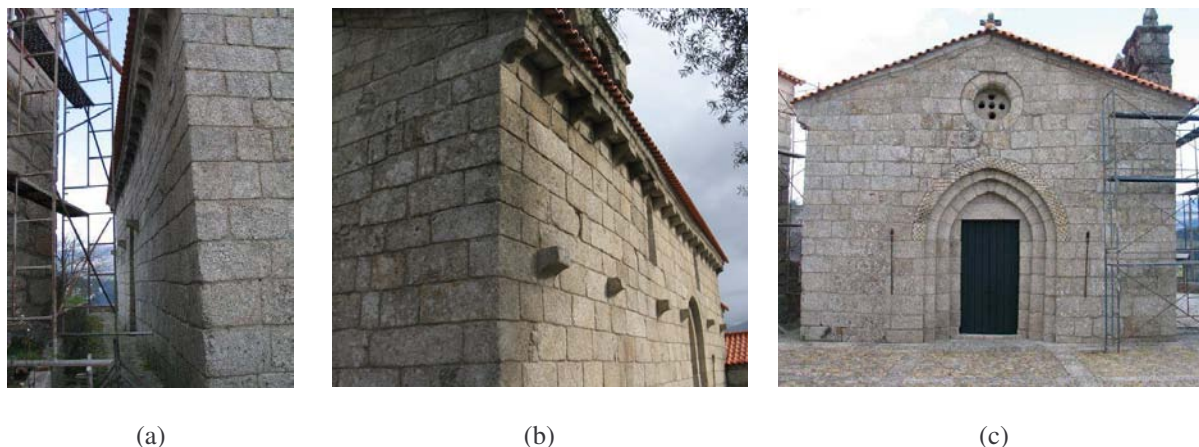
Igreja de Gondar. (a) Empena Norte. (b) Empena Sul. (c) Fachada principal.
